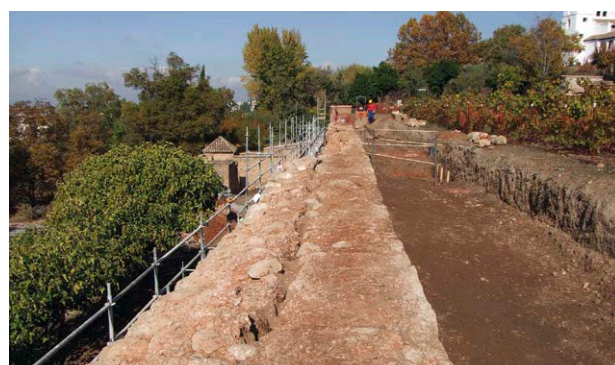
Vista hacia el sur que muestra la separación entre los dos muros.
